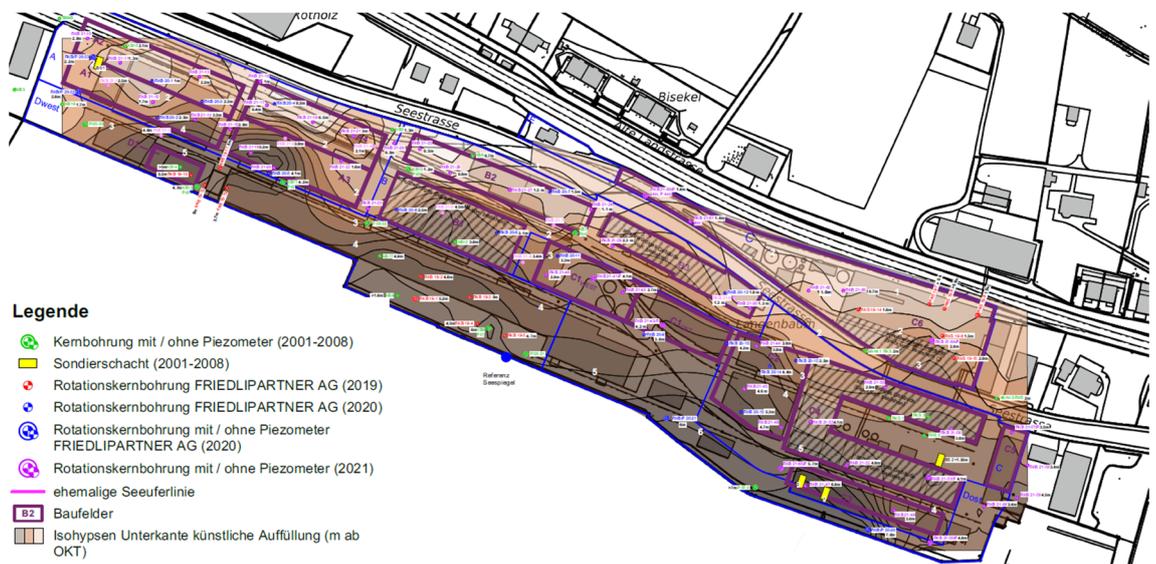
, Plan Untergrenze künstliche Auffüllungen, Friedli und Partner 2022 (Unterlage E8)
